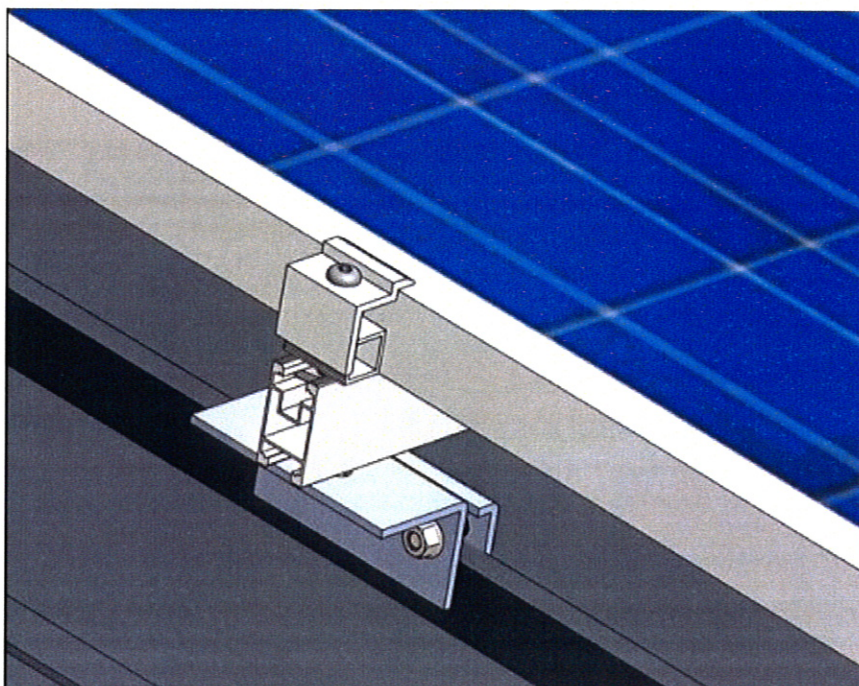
Rysunek przykładowej konstrukcji blacho – dachówka
